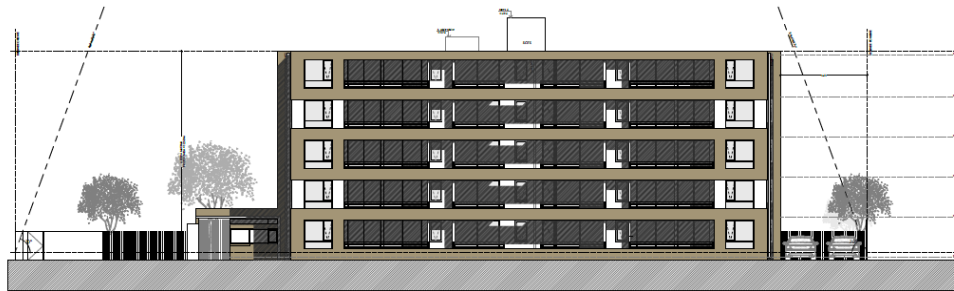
Elevación Norte. Fuente: Planos de Arquitectura Edificio Espacio Huertos, Aitue S.A.
